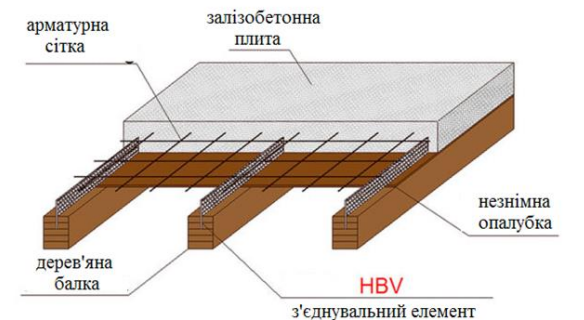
Улаштування деревозалізобетонного перекриття за HBV-технологією
